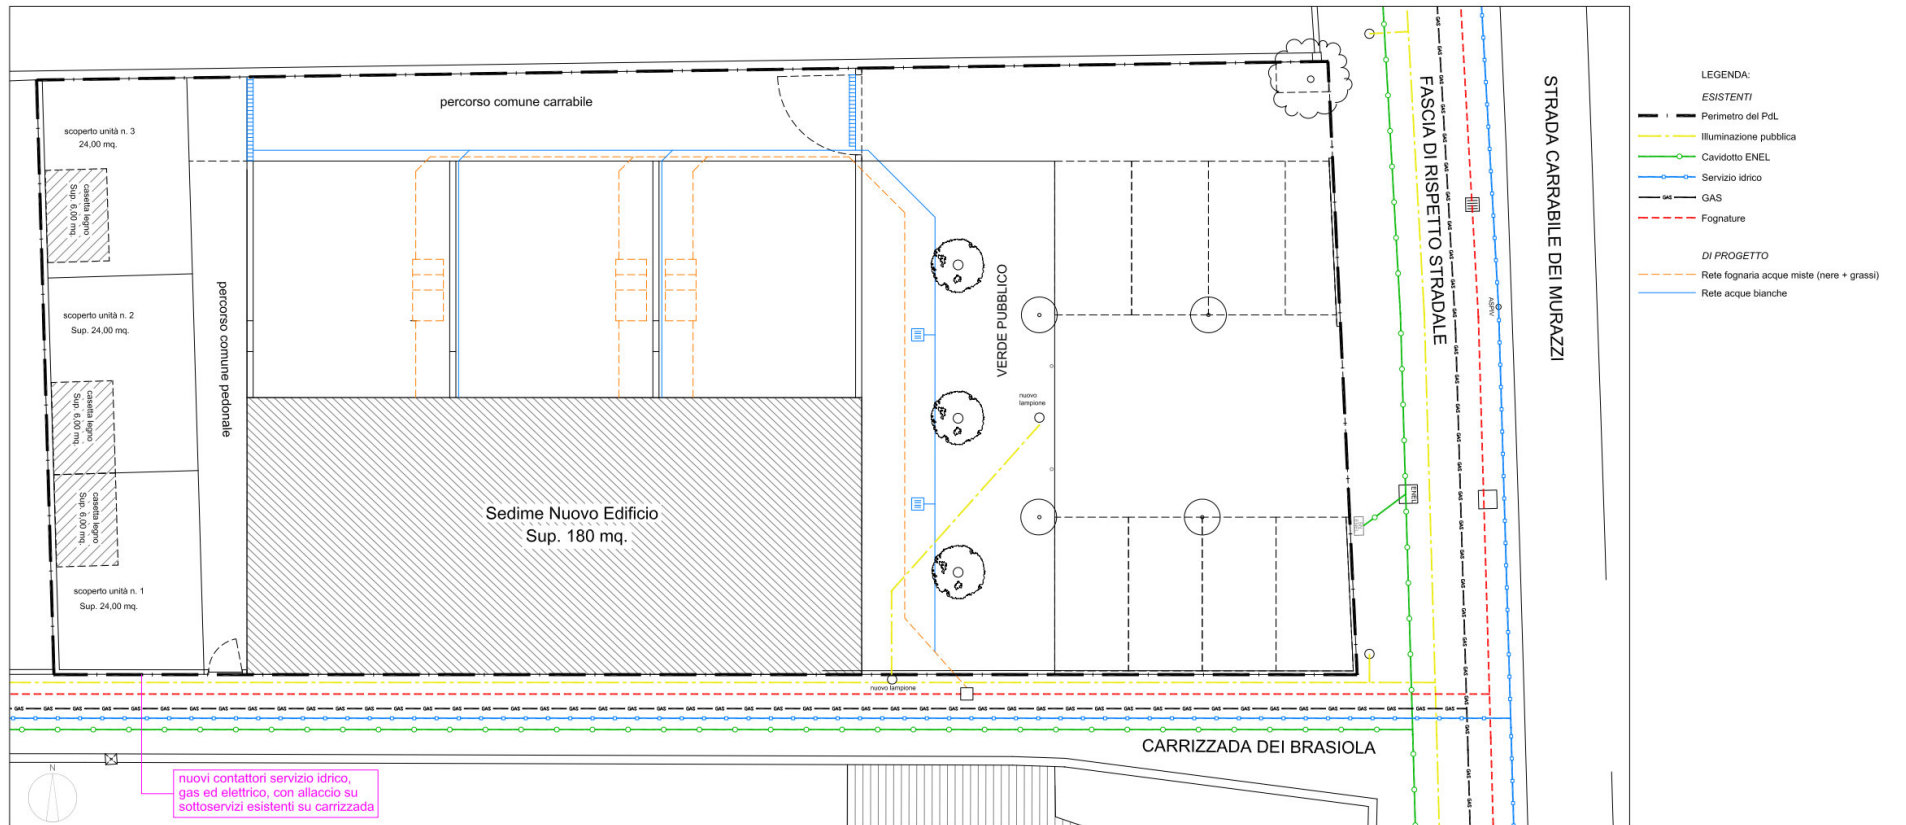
(Tav A7): Planimetria delle reti tecnologiche
